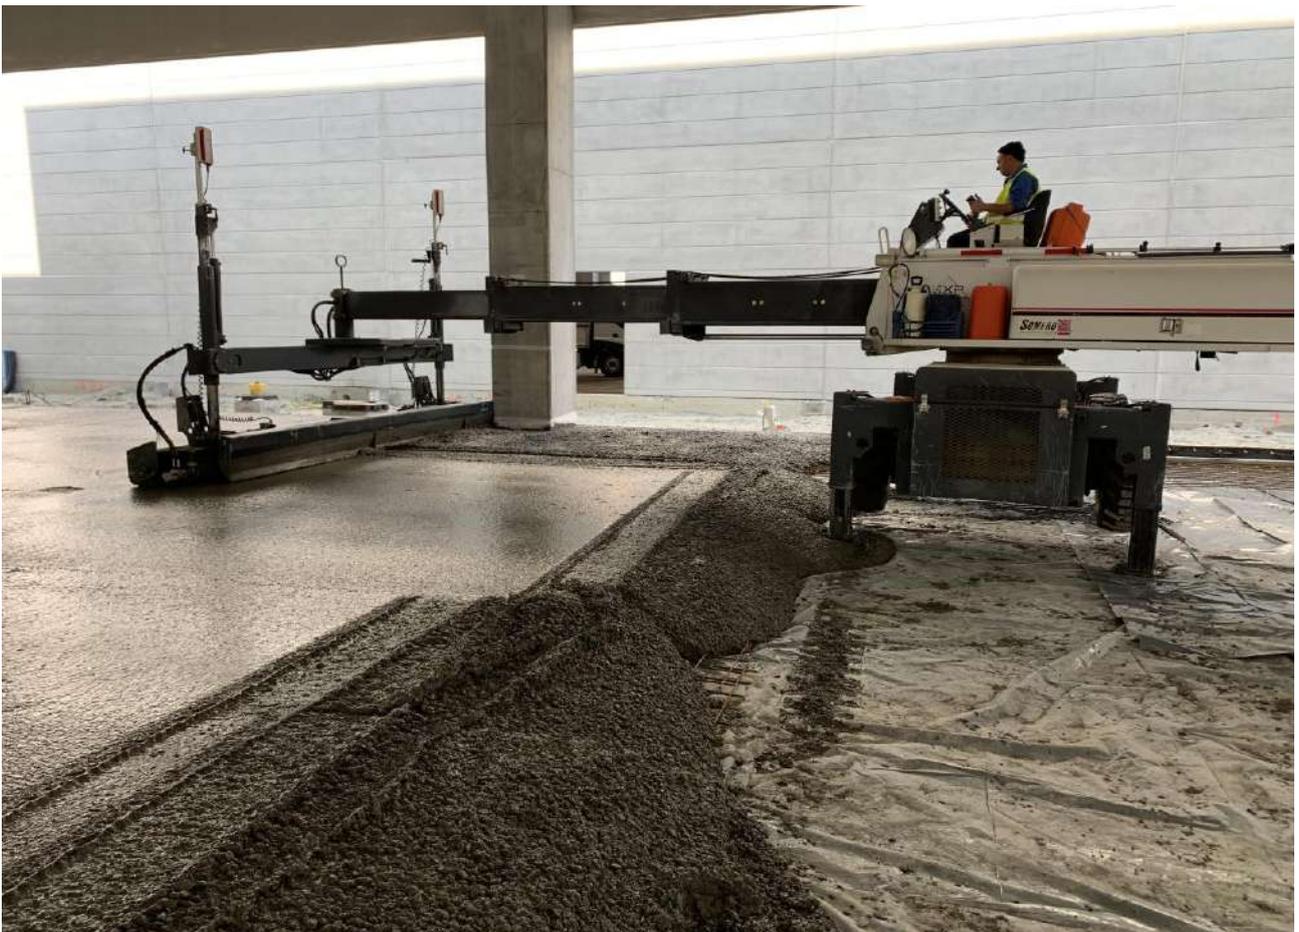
Fasi di getto della pavimentazione industriale con fibre polimeriche FIBRAG® POLY: PSF 55-TP
